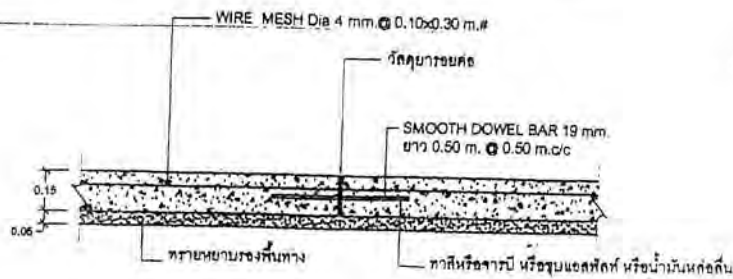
DETAIL: CONSTRUCTION JOINT (รอยต่อเพื่อการก่อสร้าง)
